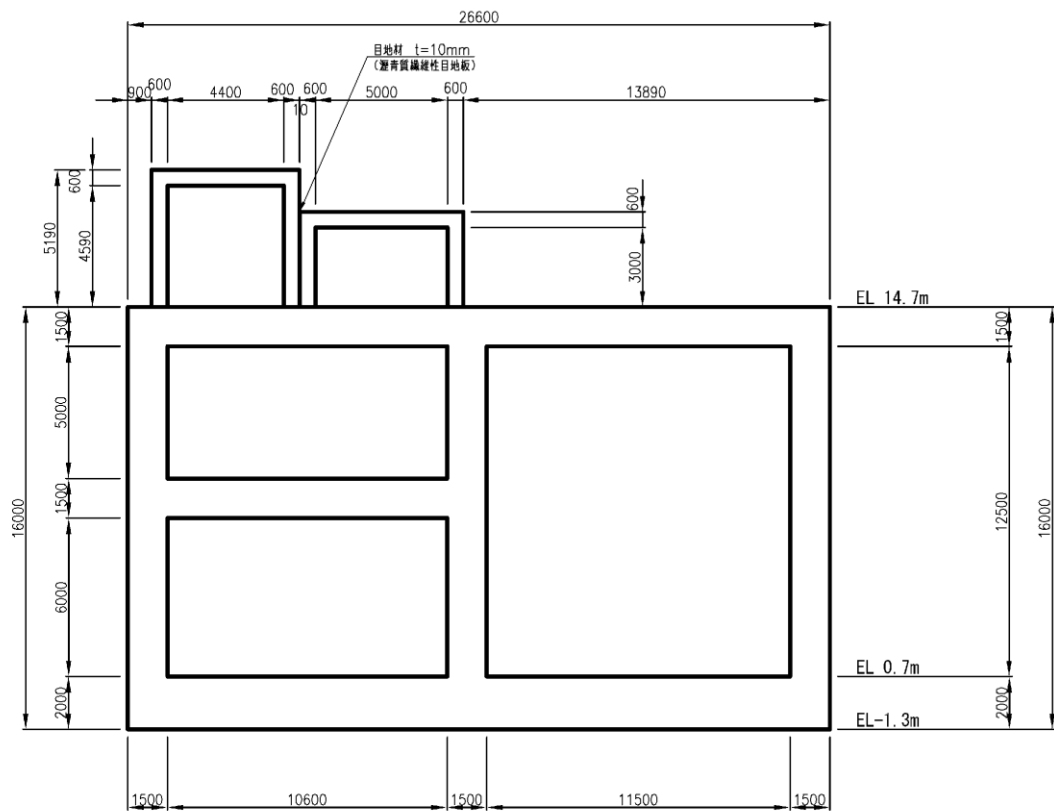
低圧原子炉代替注水ポンプ格納槽 断面図 (B-B 断面)
